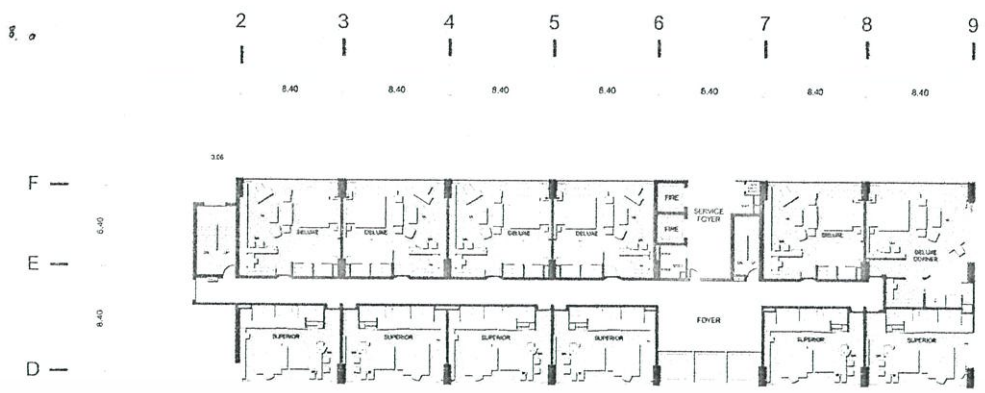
แสดง 8<sup>th</sup> FLOOR PLAN
